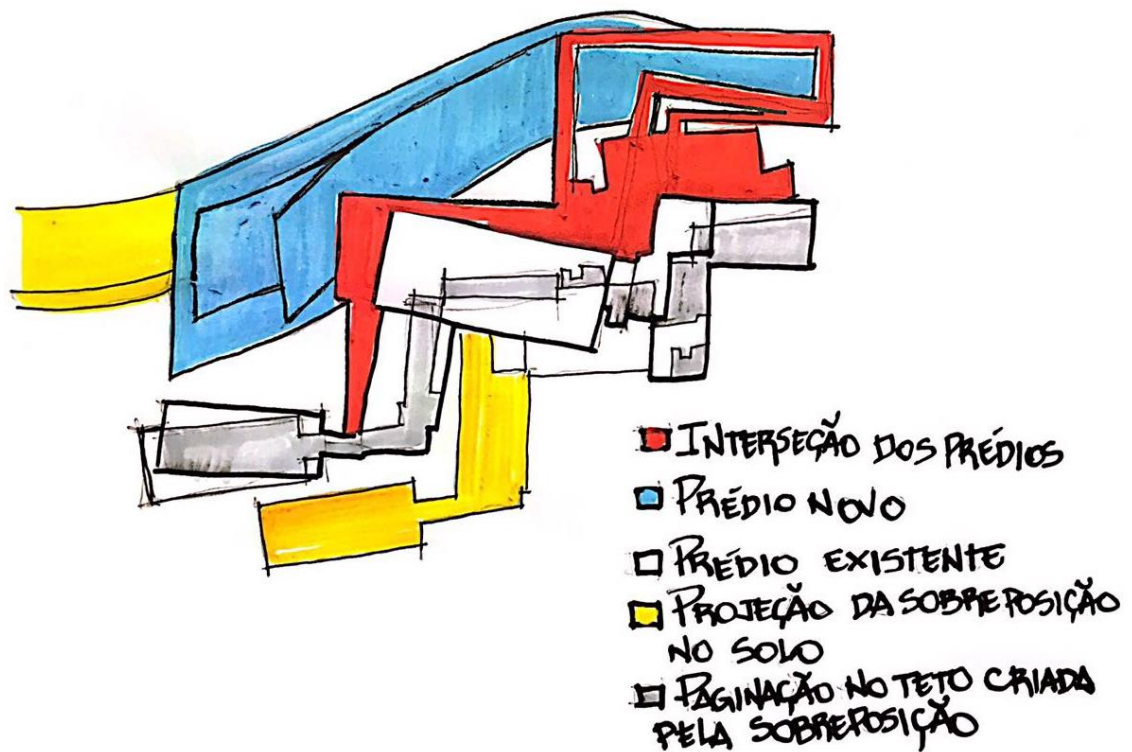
Sobreposição dos pavimentos, a forma evidencia o processo.
